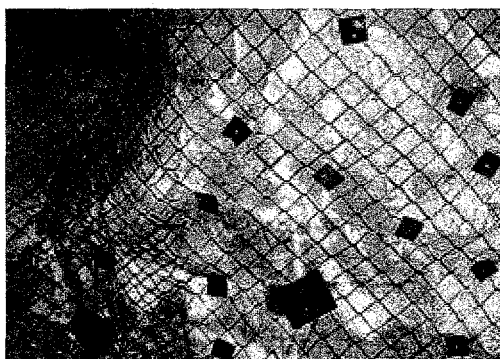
Boulonnage d'un pilier et filet de protection (photo Collet, carrière de gypse de l'Est parisien, 2001)
